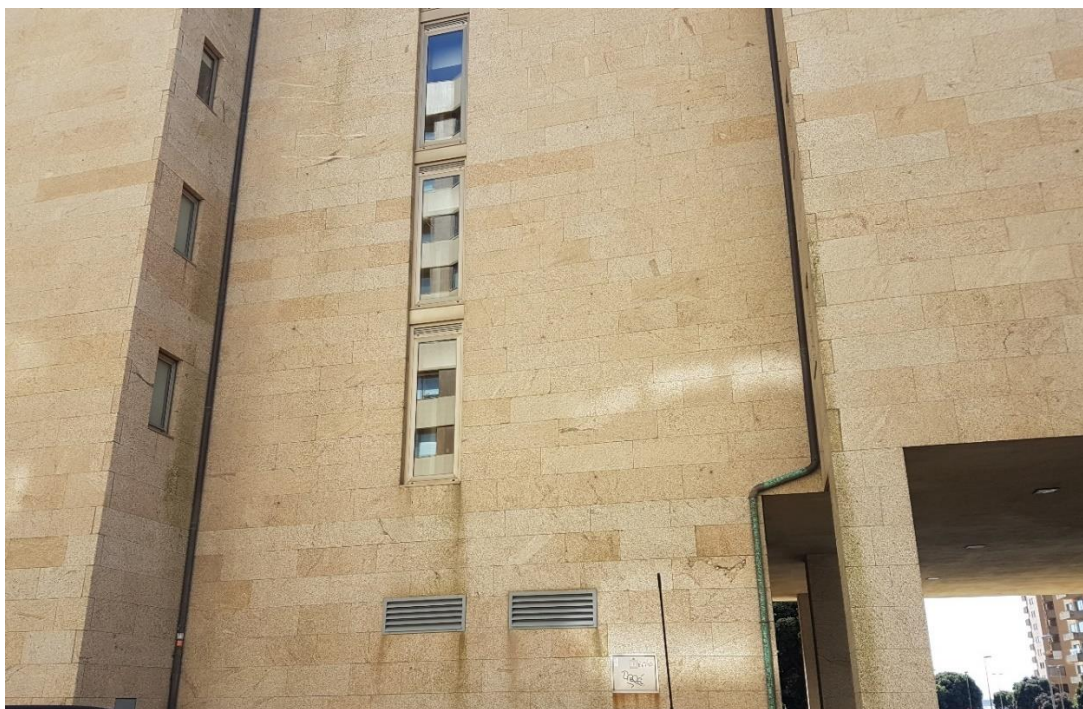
Canto interior da fachada Este do edifício 17.
